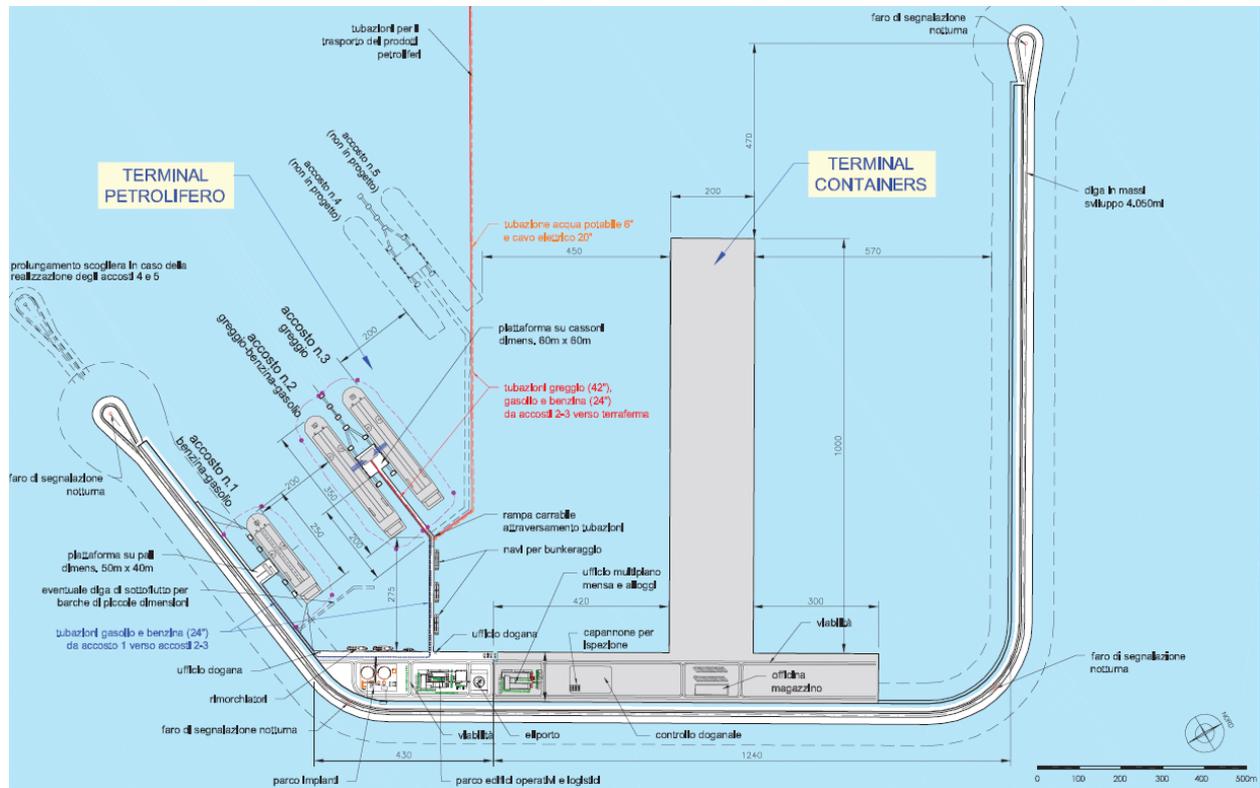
Planimetria Generale Terminal Plurimodale Offshore
